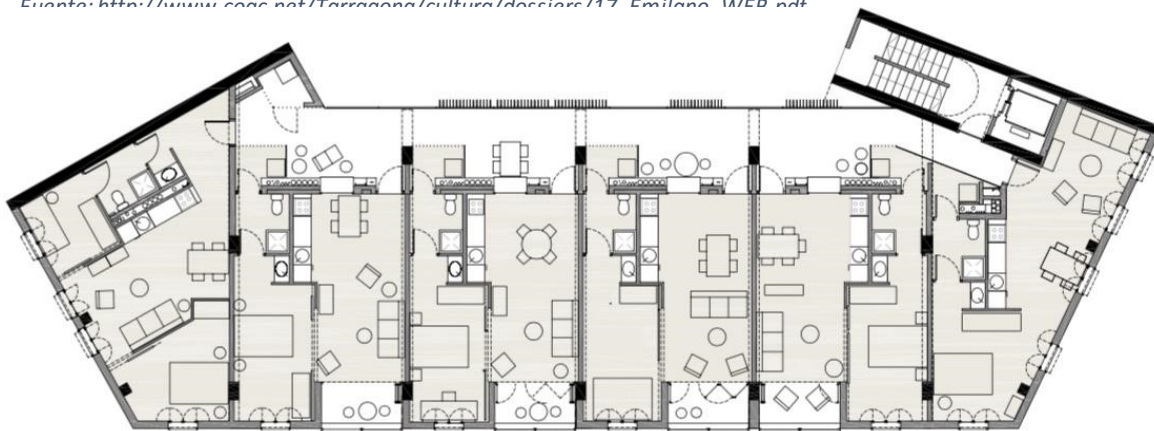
Planta: Viviendas de Protección Oficial en Barcelona. Fuente: http://www.coac.net/Tarragona/cultura/dossiers/17_Emilano_WEB.pdf
